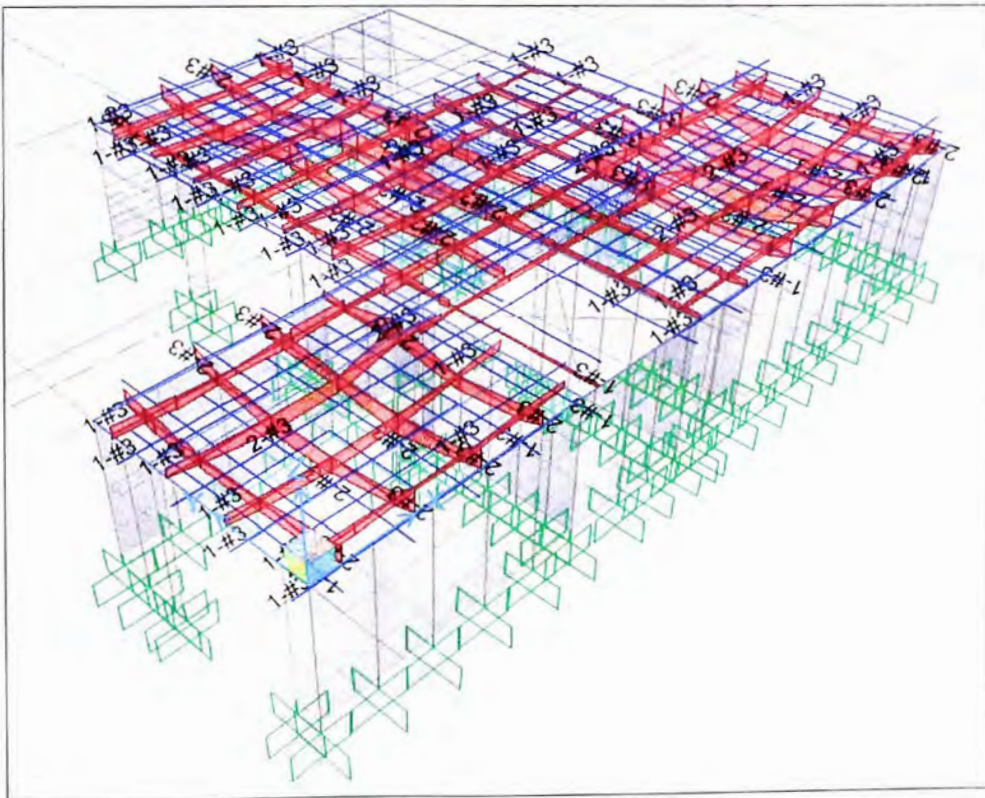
Armado final de la losa maciza en dos direcciones; primer piso.
